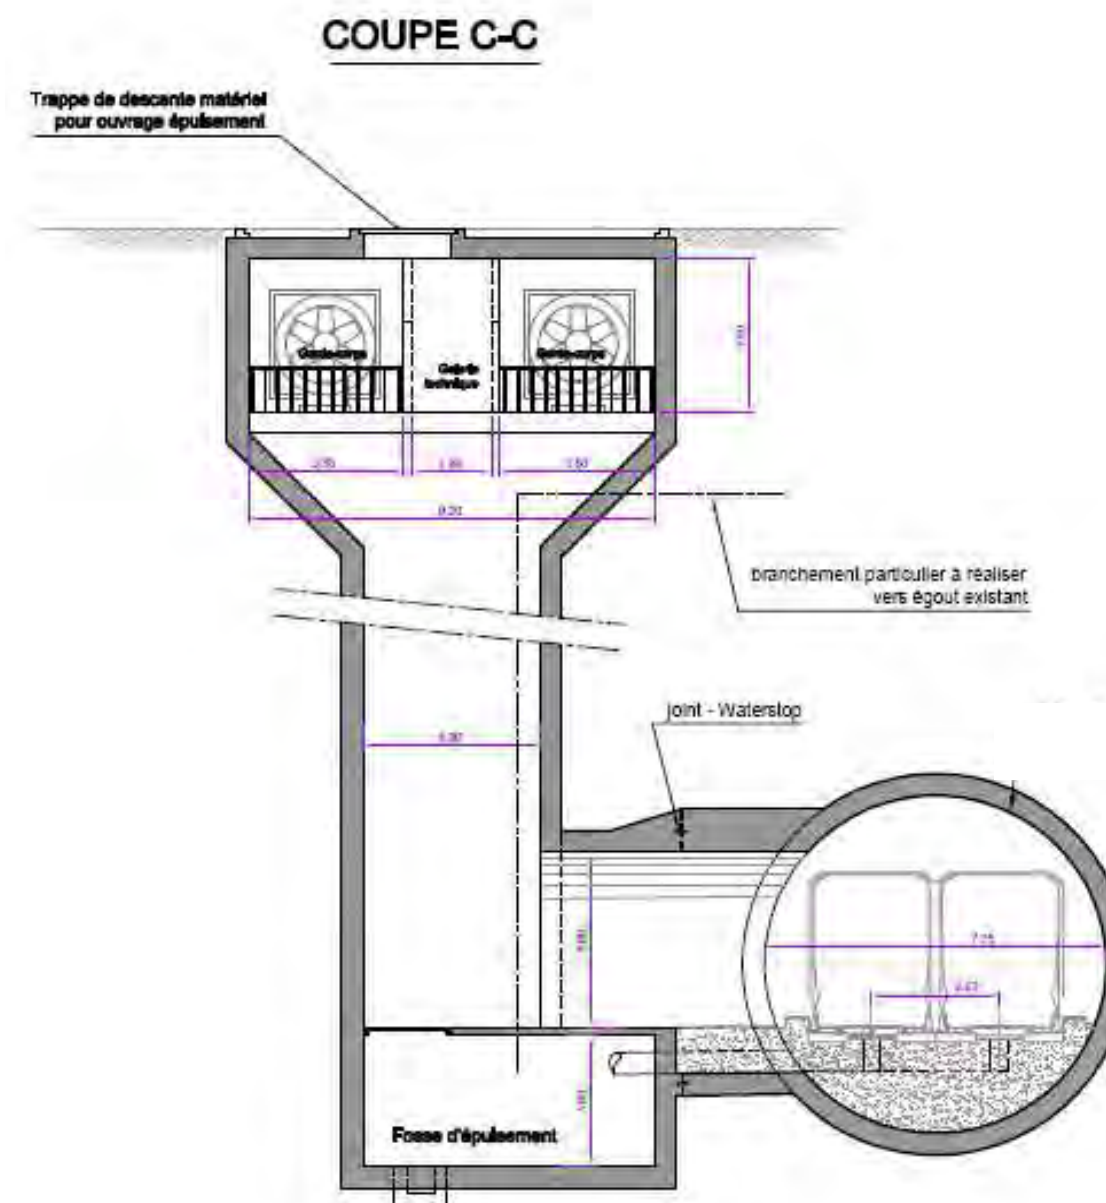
Plan type (h>30m) – Coupe d'ouvrage annexe sur Puits de Ventilation, (Source : Société du Grand Paris)
